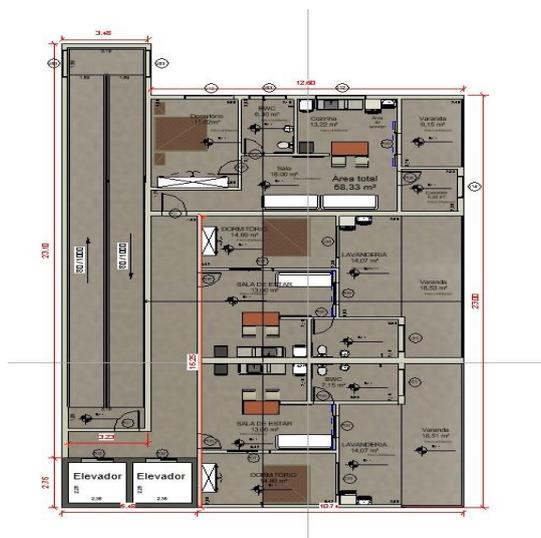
Planta Baixa Pavimento Tipo I
